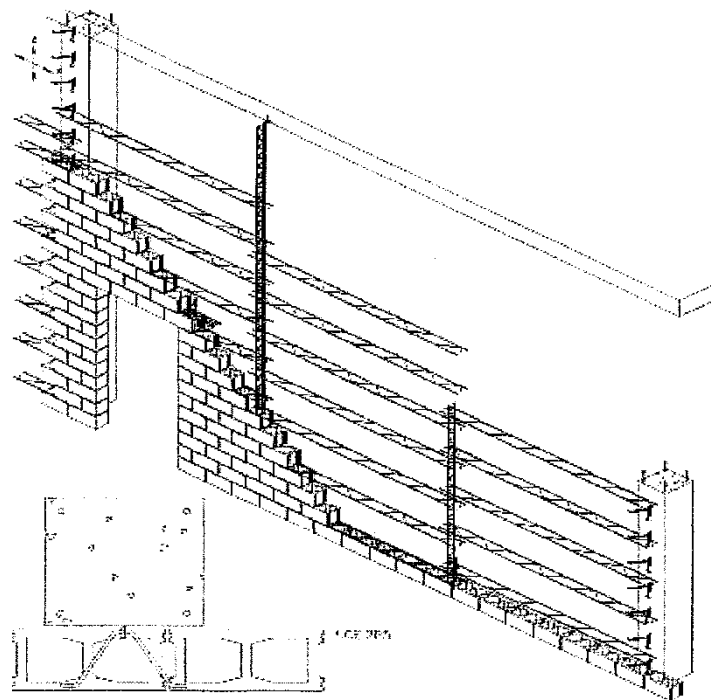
Fachada de bloques de hormigón armado y arriostrado.
